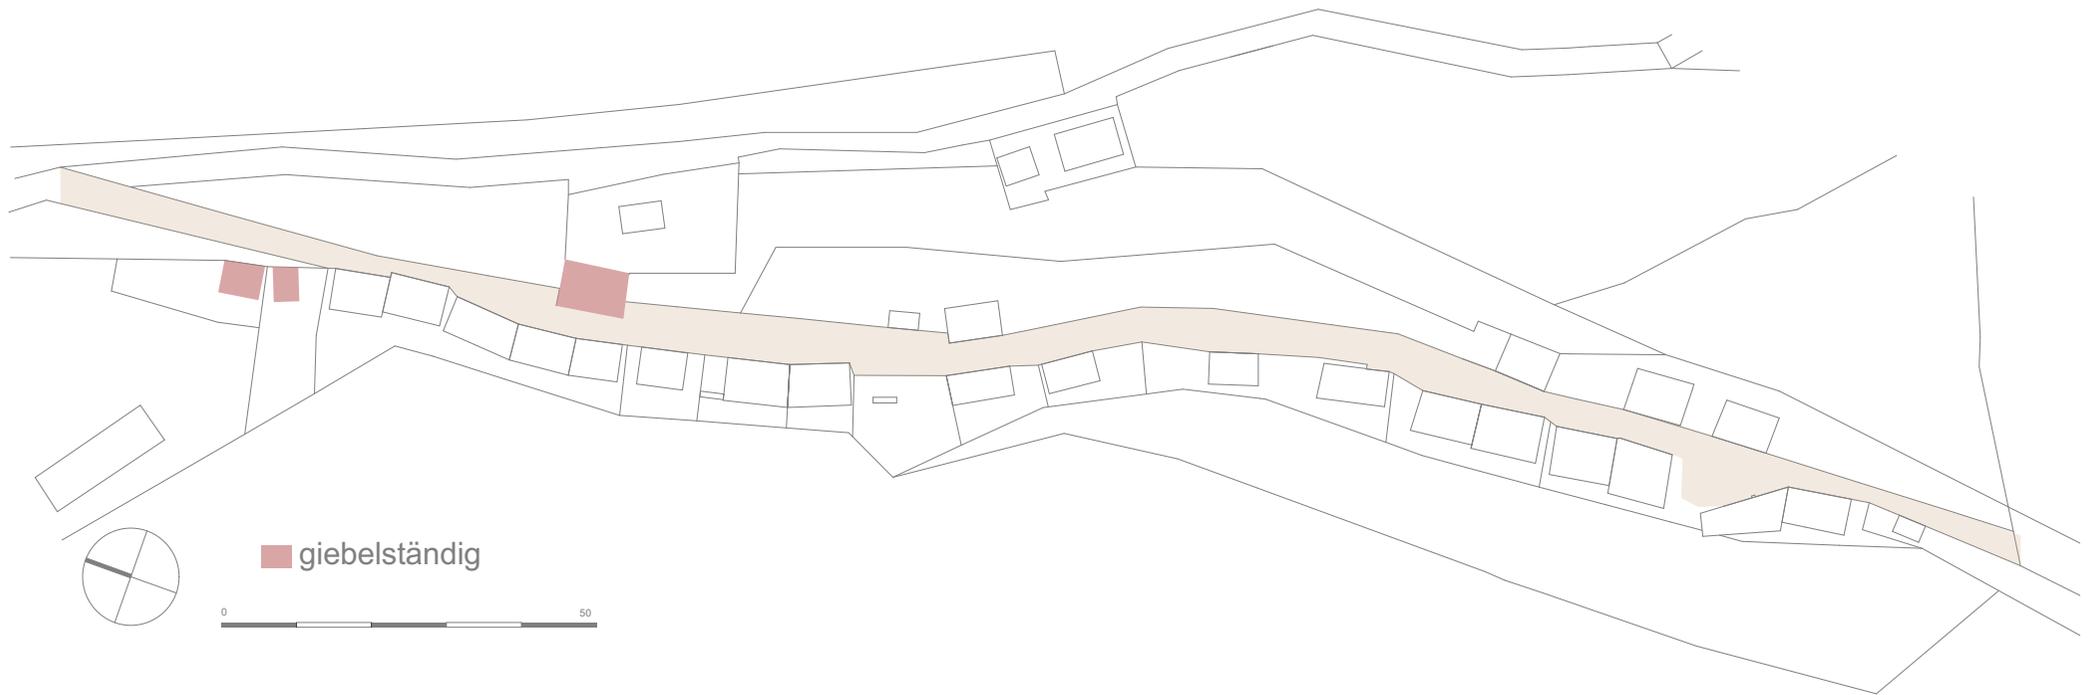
Lageplan giebelständige Presshäuser 1:1000
